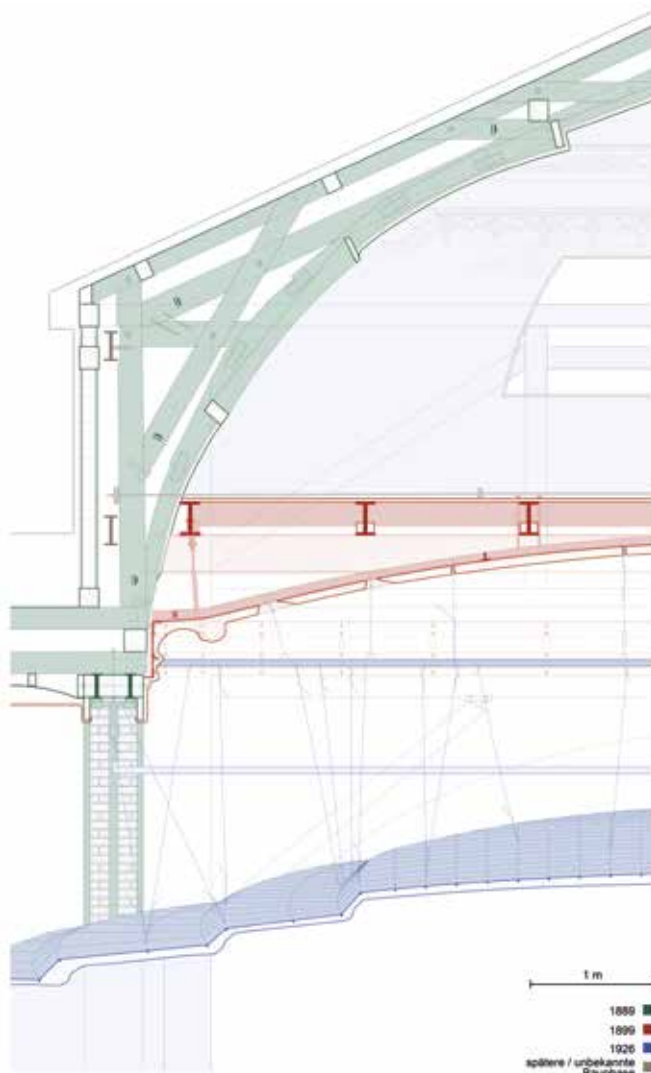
Konstruktionsschnitt durch den Dachraum des Pfauens, Professur für Bauforschung und Konstruktionsgeschichte, ETH Zürich, Bauaufnahme 2019/20
